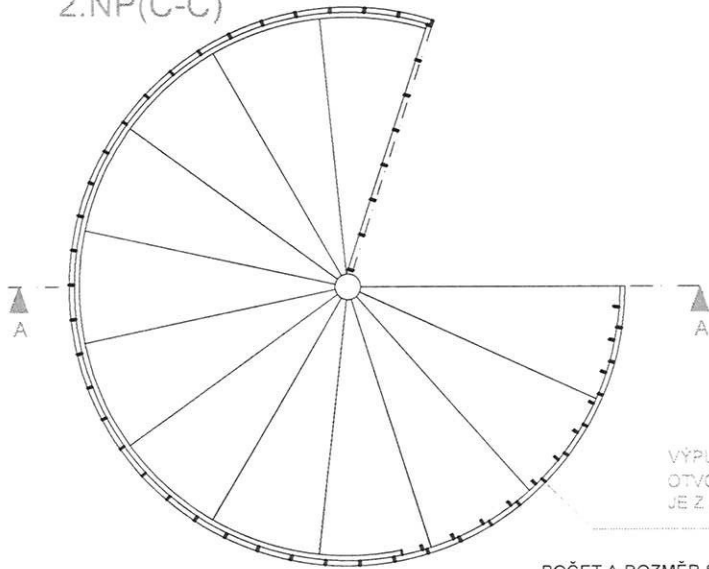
DETAIL ZÁBRADLÍ SCHODIŠTĚ
